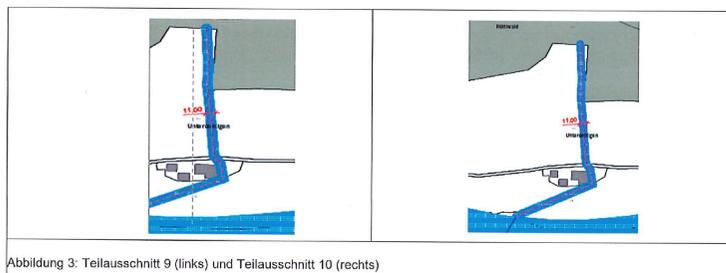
Teilausschnitt 9 (links) und Teilausschnitt 10 (rechts)
